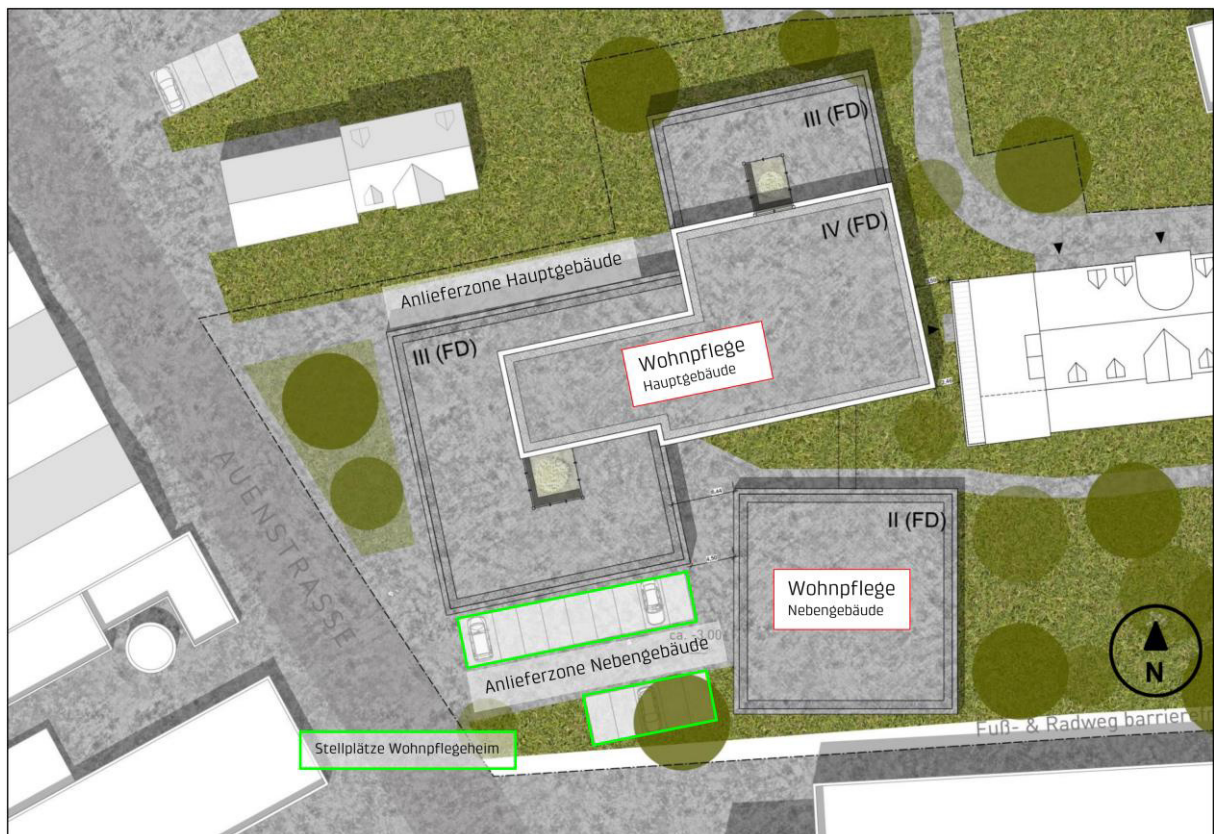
Lageplan mit Darstellung der Wohnpflegeeinrichtung
